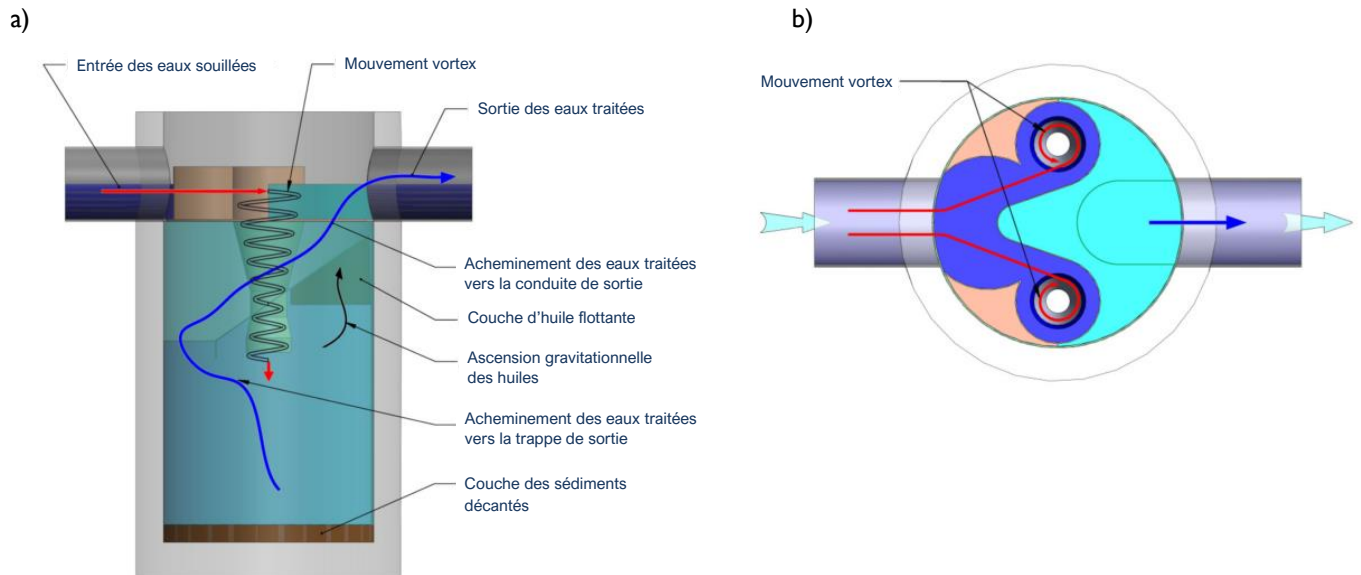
a) Vue en coupe et b) Vue en plan illustrant l'écoulement dans le système déshuileur dessableur SDD3 de NEXT Stormwater Solutions.
